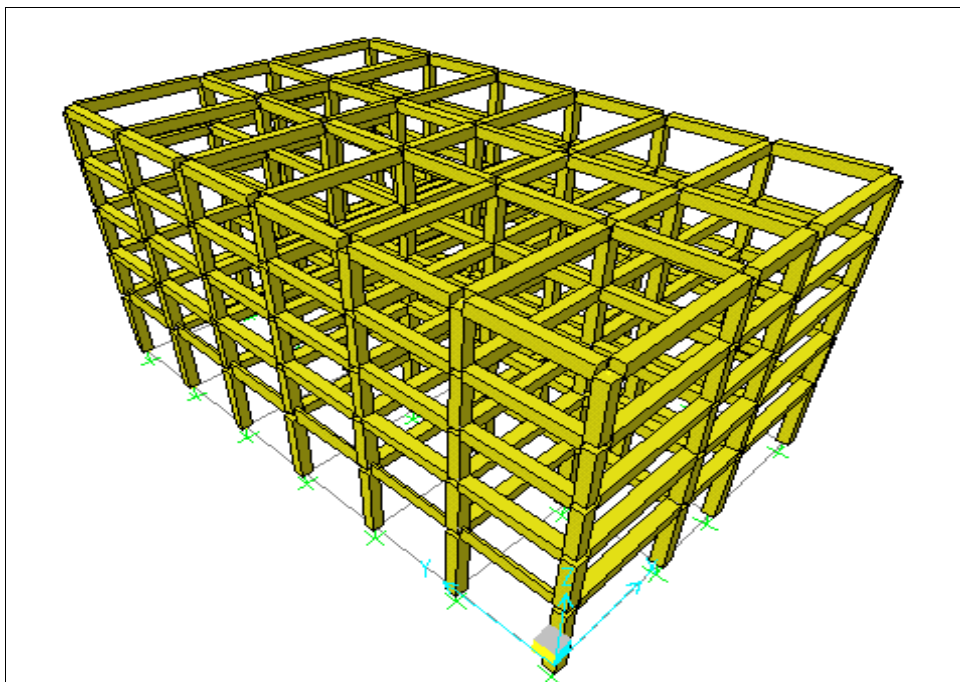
Modelo Tridimensional de la Estructura de base fija considerando el modelo empotrado a nivel del plano de fundación(Realizado en el Sap-2000 7.42).
